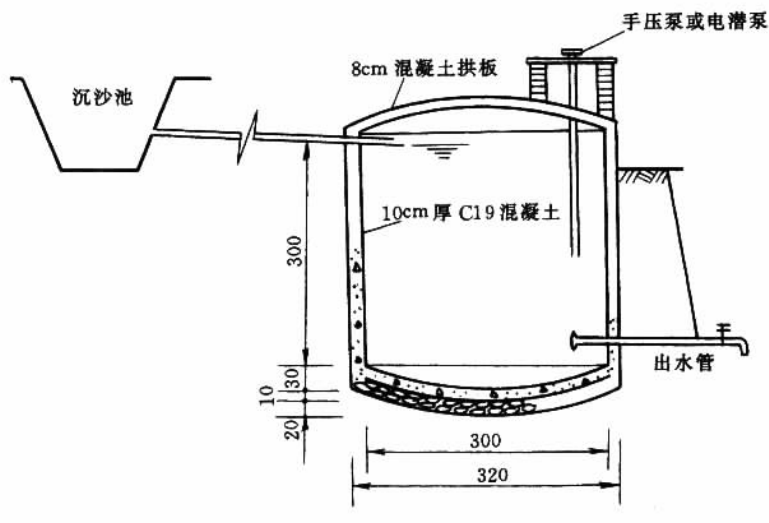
封闭式圆形蓄水池剖面图 (单位: cm)
